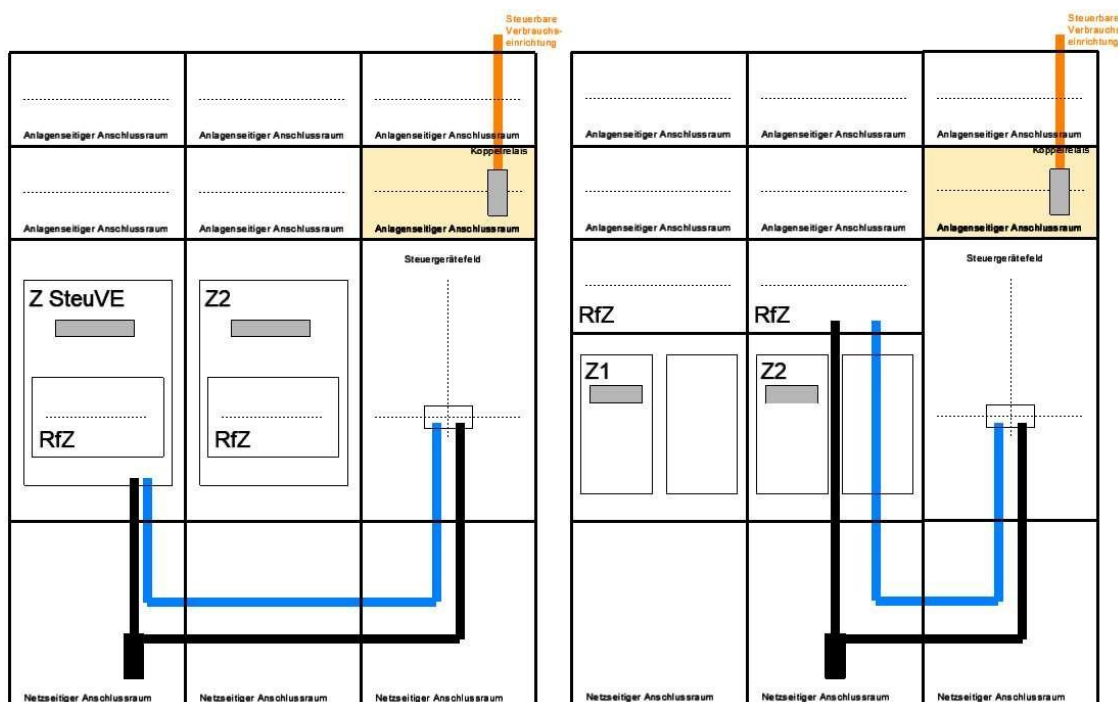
Bestandszählerplatz mit einem Steuergerätefeld
